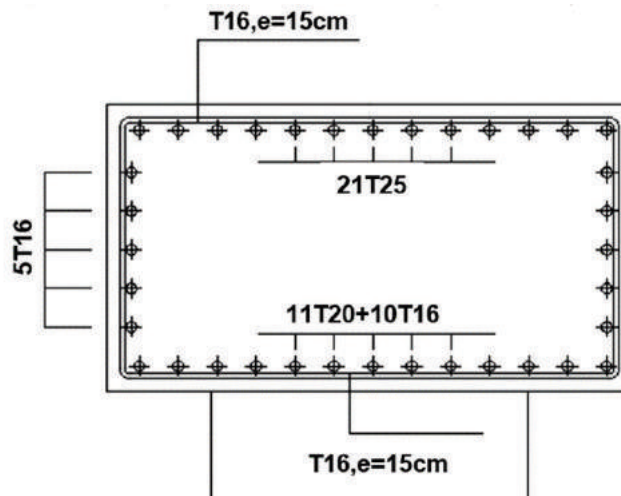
Ferrailage de chevêtre (coupe transversale).
